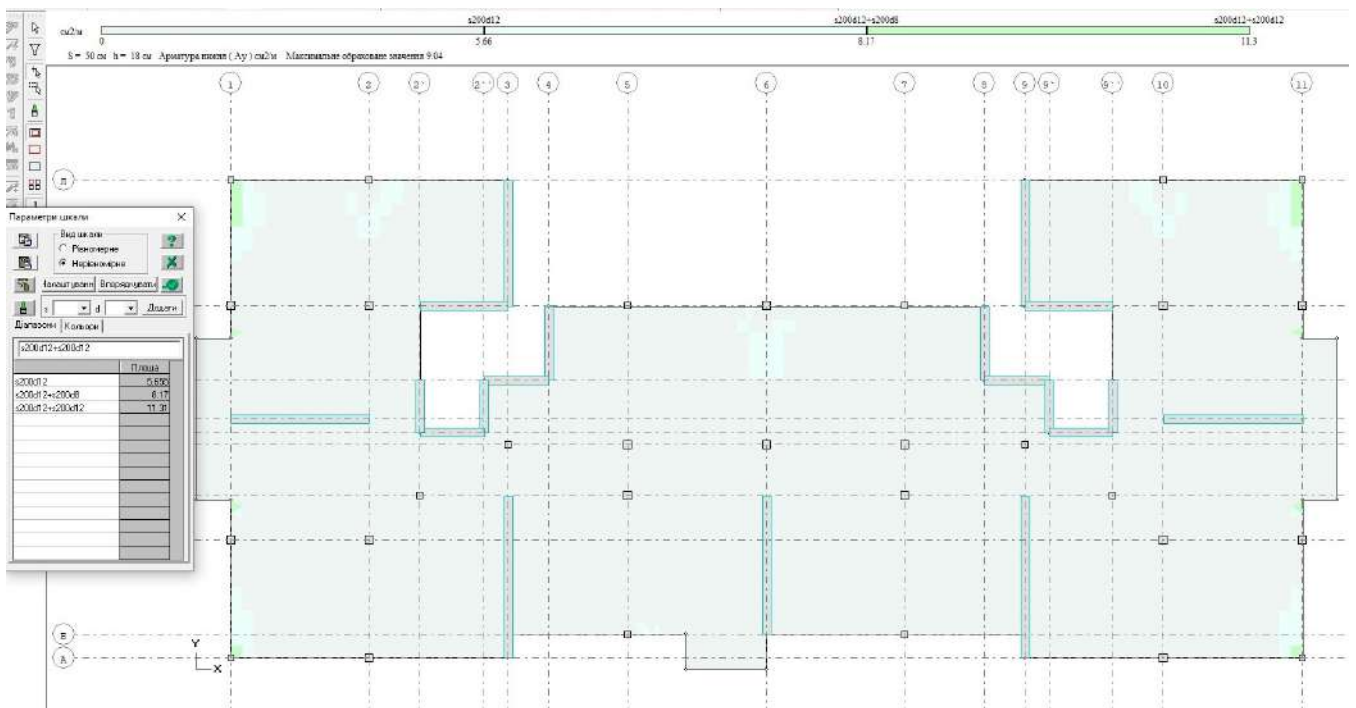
Схема армирования по оси Y нижней части плиты
